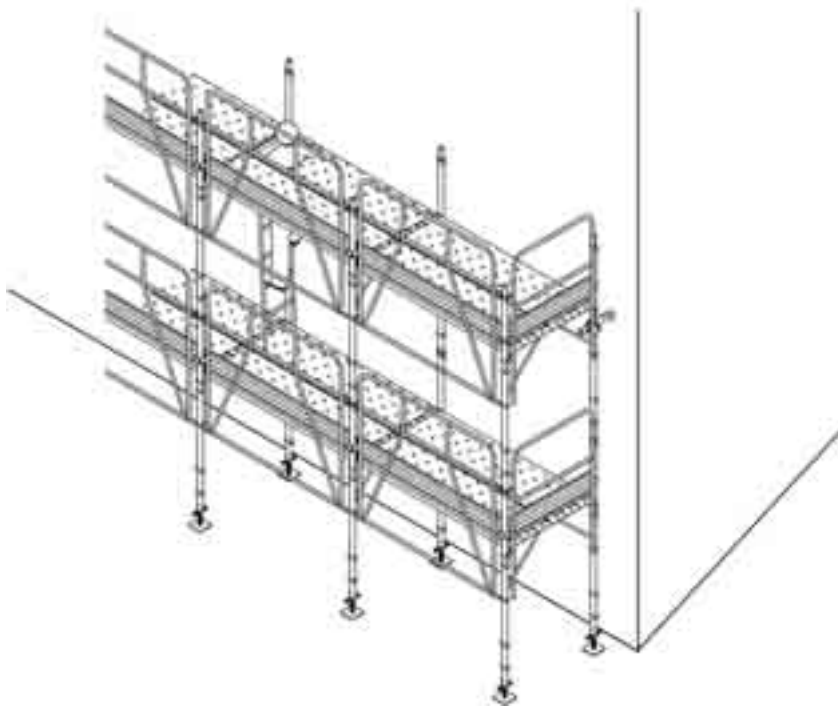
Fasi di montaggio dal basso del ponteggio con parapetto di protezione collettivo
